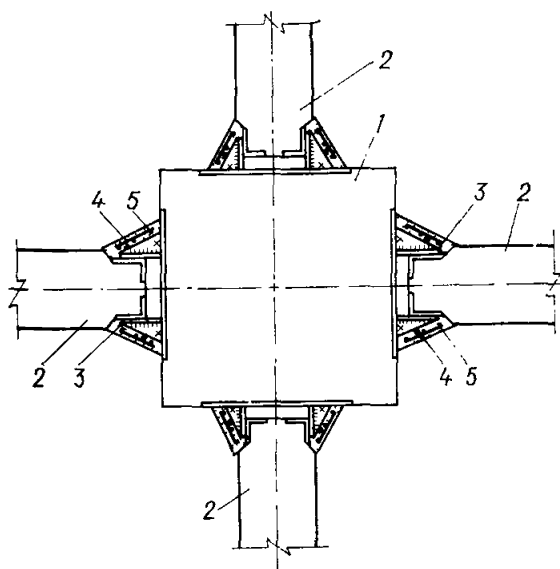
Деталь соединительных планок сборной плиты бункера
